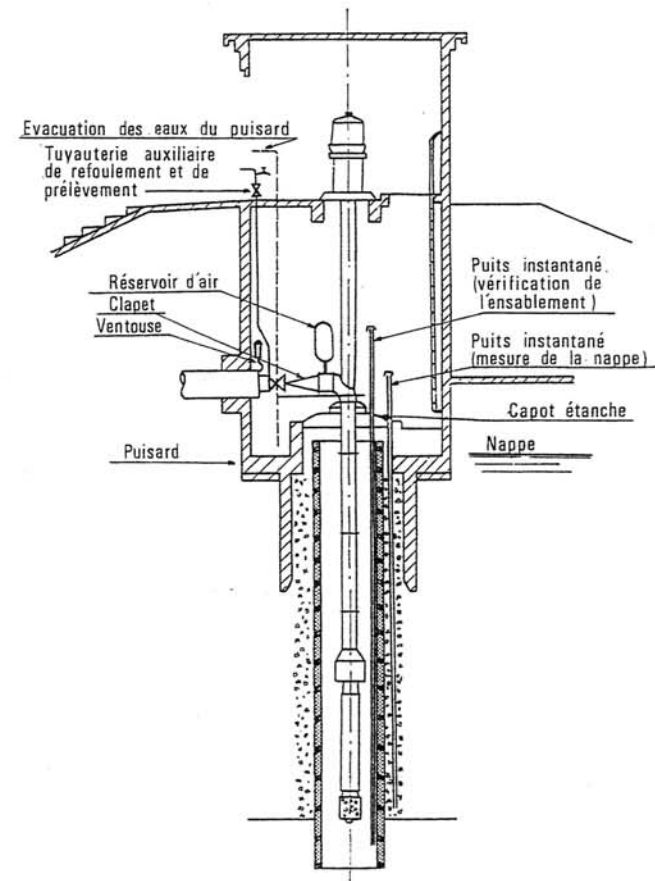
Coupe-type d'une installation de pompage sur puits.
